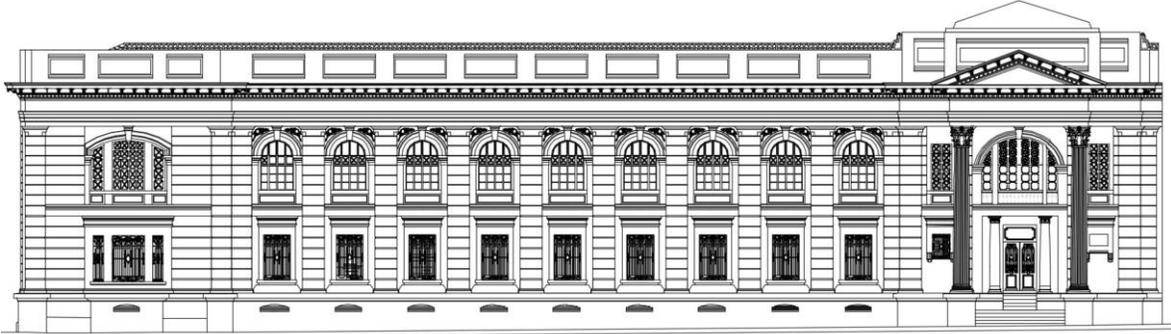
Fachada sobre calle 10 - LA FACULTAD
